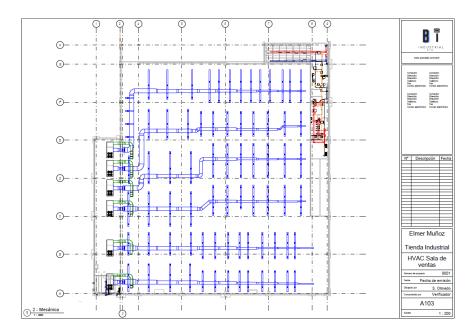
Ejemplo plano Sistema HVAC. Elaboración propia
